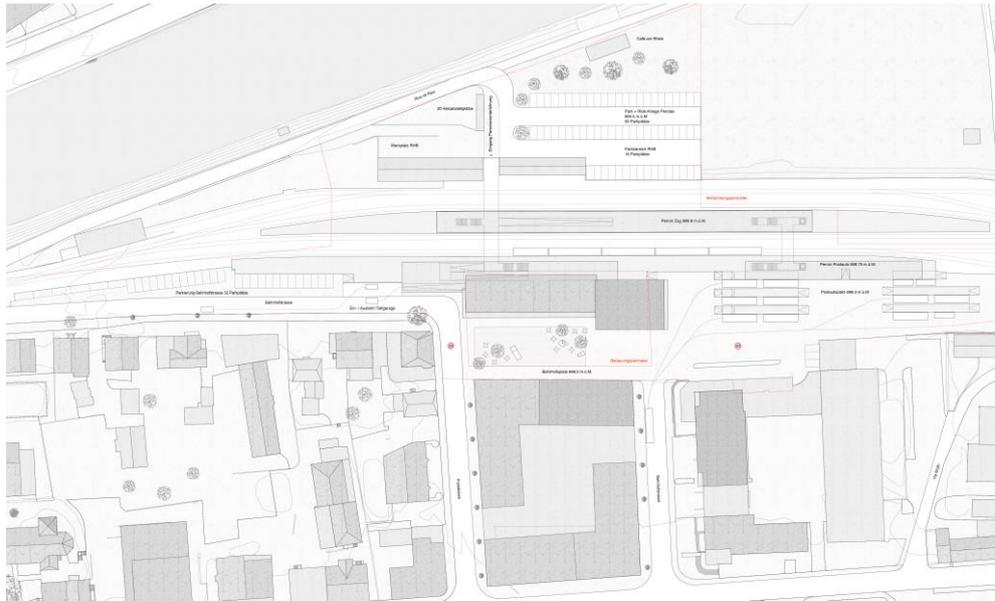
Situationsplan «viadi» (nicht massstäblich)
